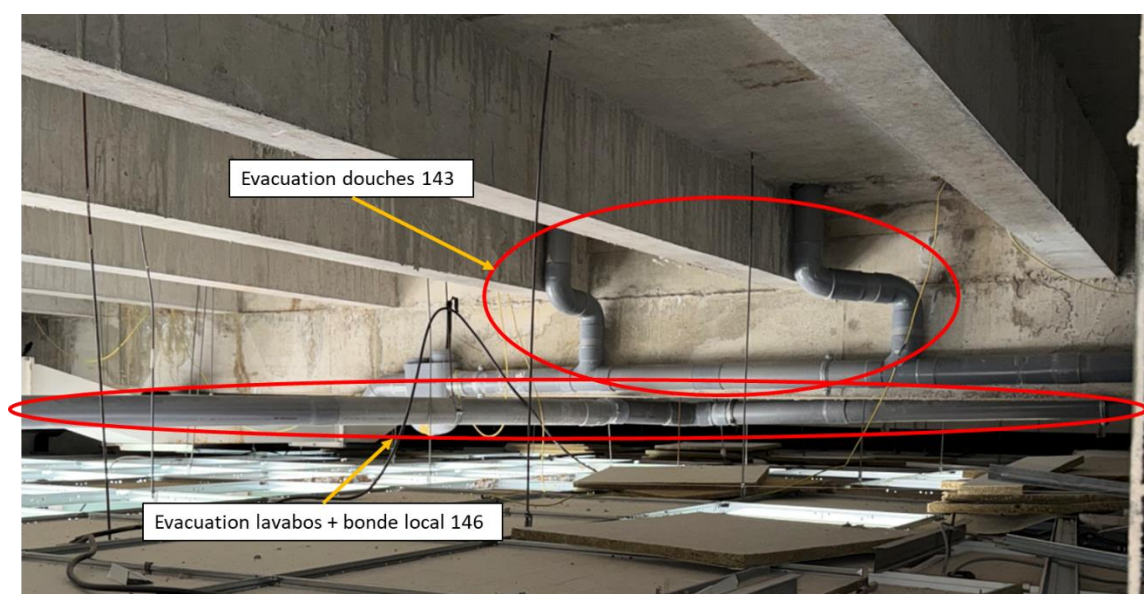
évacuations lavabos + douches (faux plafond local 133)
